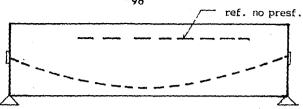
Refuerzo no presforzado para fortalecer una viga precolada durante su manejo y erección.
